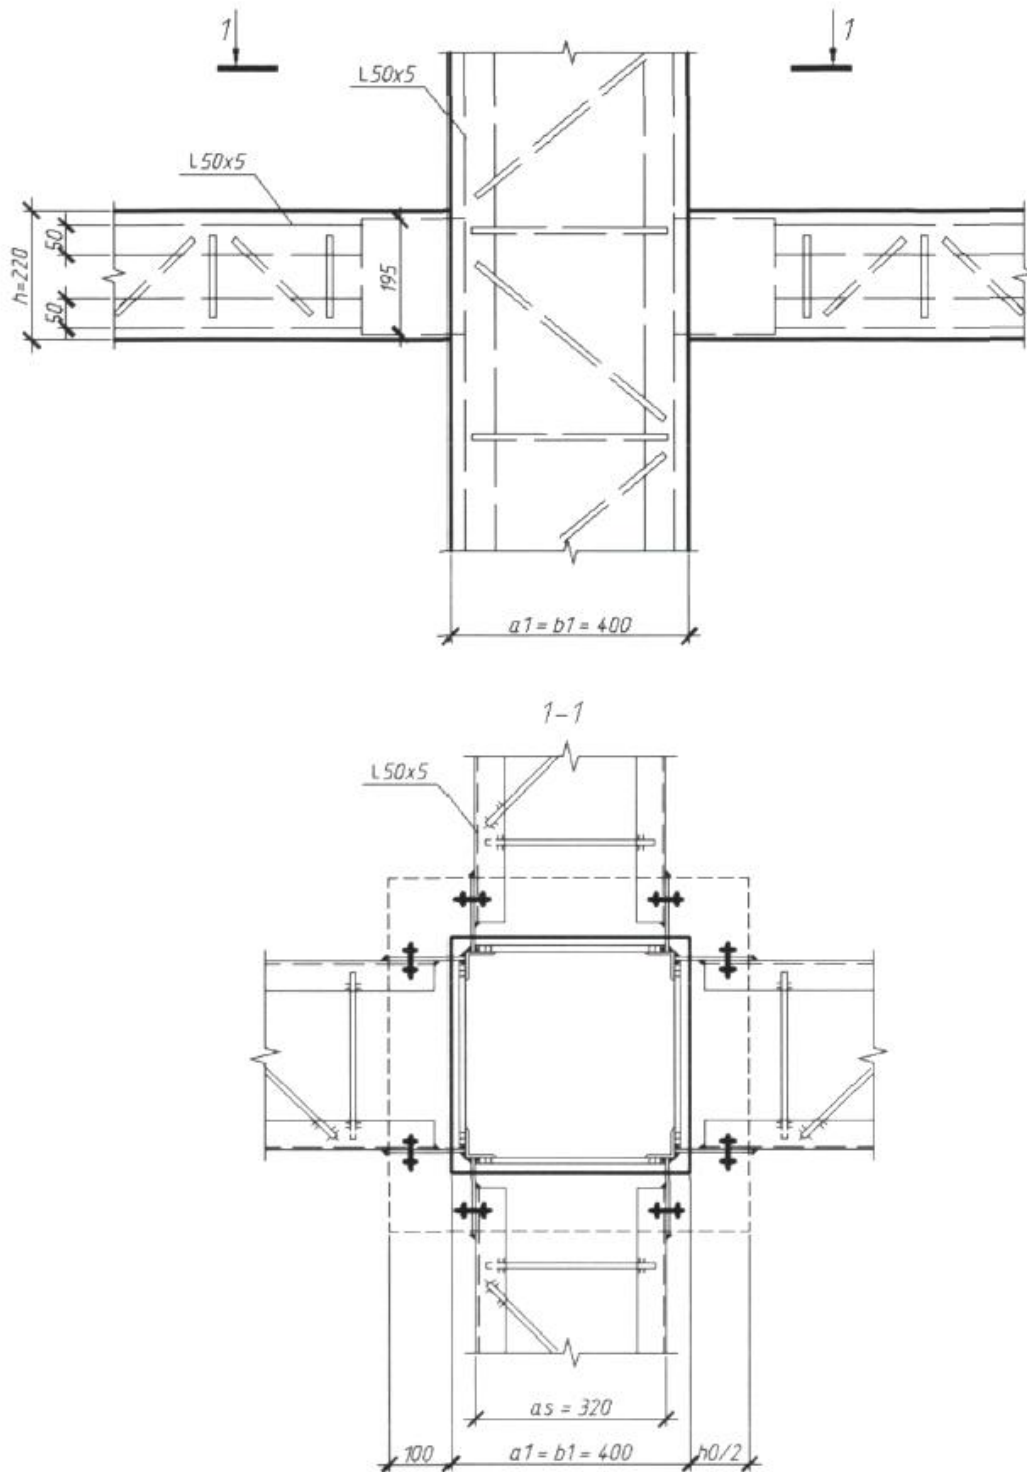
Розташування жорсткої арматури у вузлі «плита-колона», стержнева арматура умовно не показана
